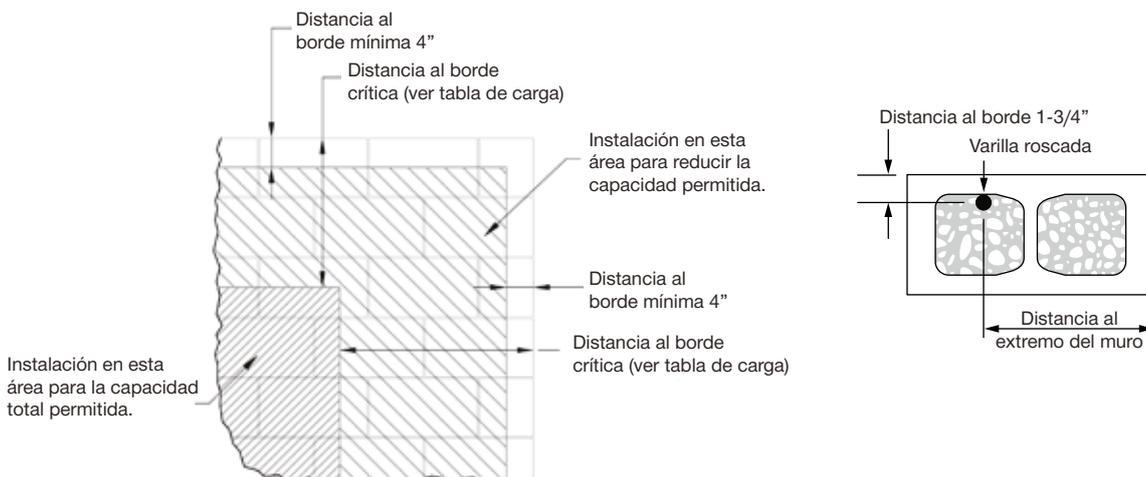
Distancias al borde para los anclajes instalados en la cara vertical de la construcción de muro de mampostería de concreto (izquierda); Distancias de bordes y extremos para varillas roscadas instaladas en la parte superior de la construcción de muros de mampostería CMU rellenos
